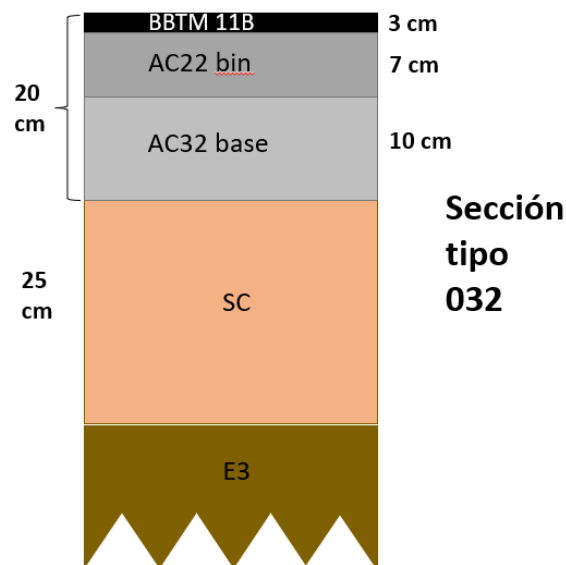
Esquema de sección de firme tipo 032 propuesta en el proyecto. Fuente: Elaboración propia.
